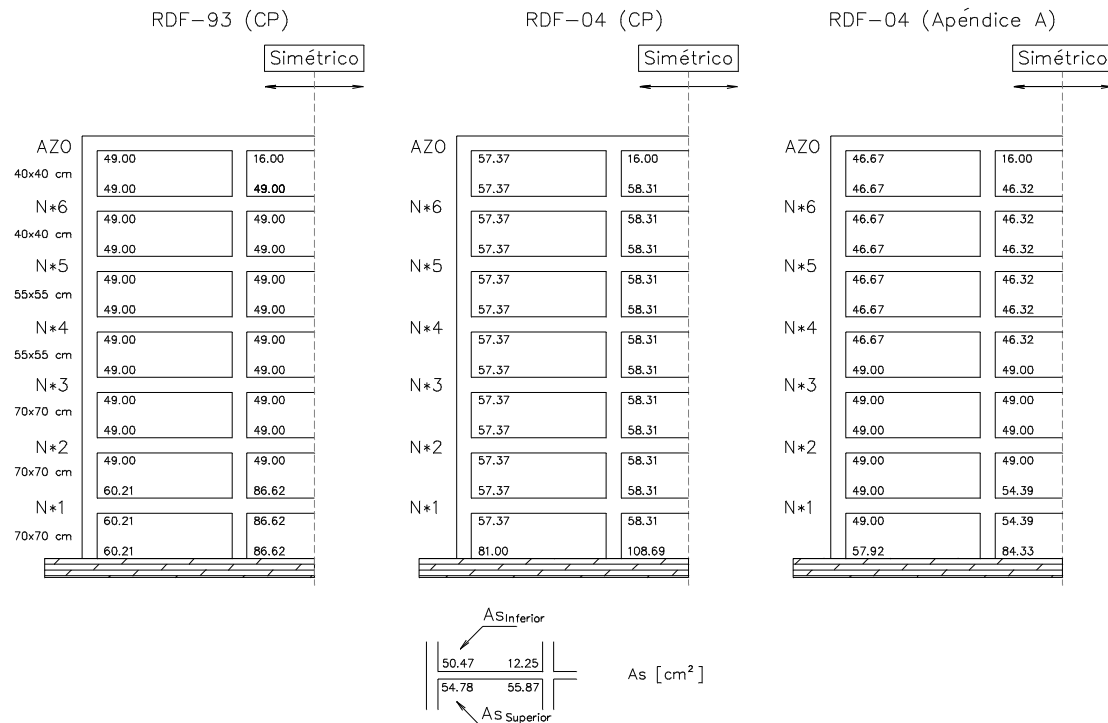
Comparación de áreas de acero de refuerzo longitudinal de las columnas del eje 2 de las estructuras diseñadas en zona III (RDF-93 y RDF-04)
